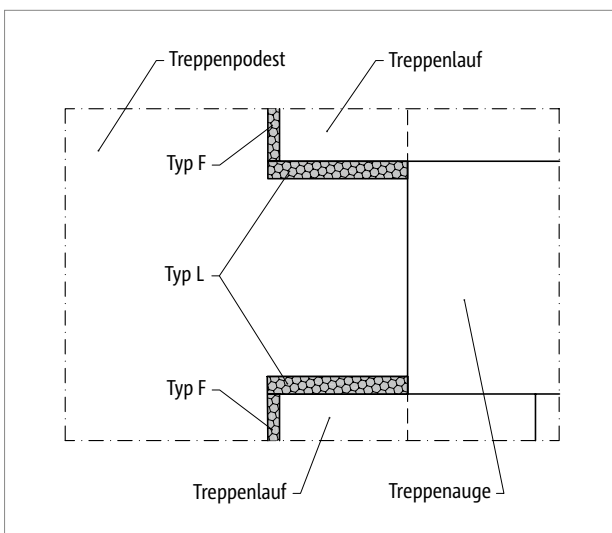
Schöck Tronsole® Typ F: Elementanordnung, Detail A
